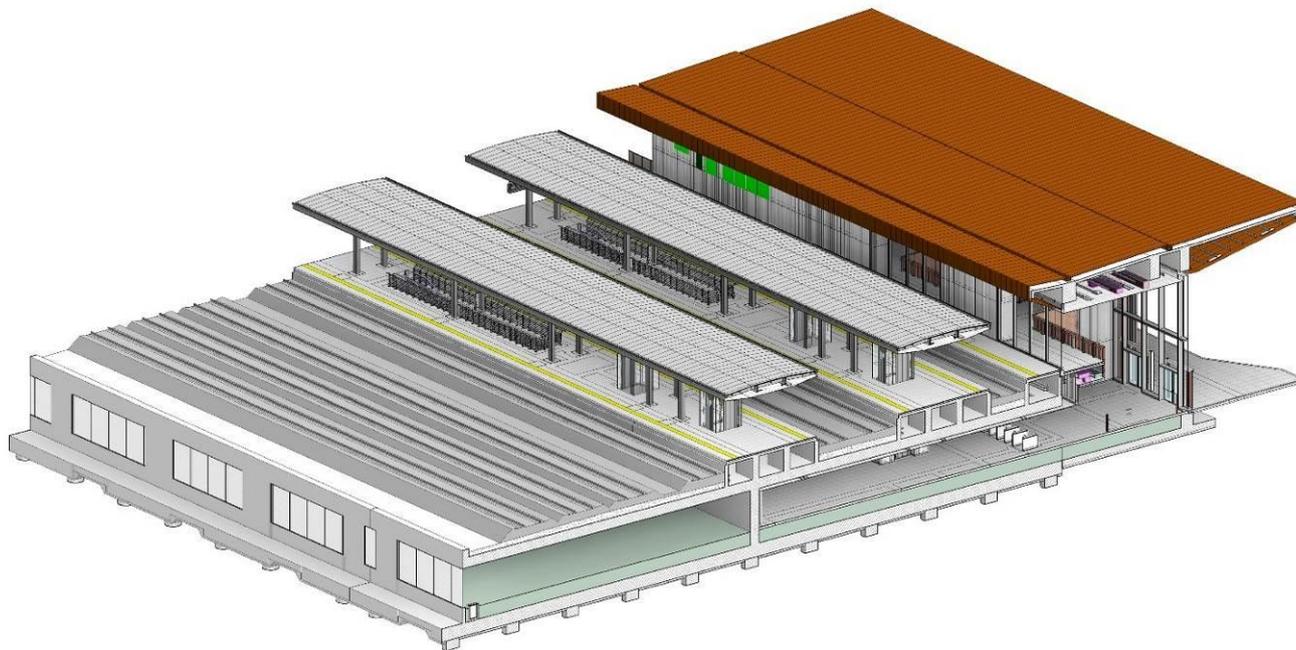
Spaccato assometrico banchine e parcheggio
